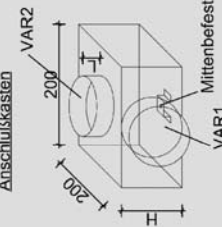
DETAIL ZULUFTBODENAUSLAß IN ZWISCHENDECKE
